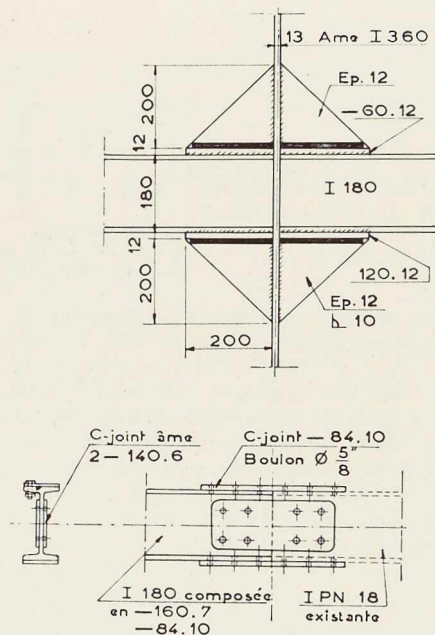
Modifications apportées aux linteaux reliant les colonnes en façade.
